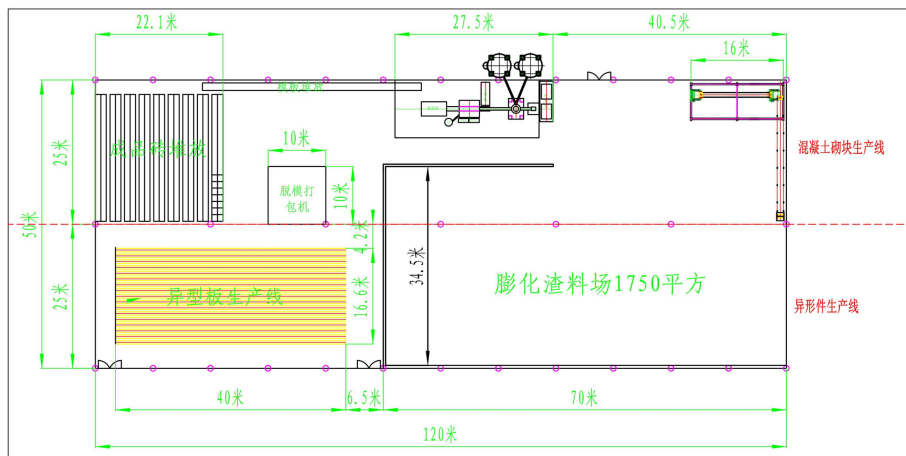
环评阶段新建厂房（异形件和混凝土砌块生产线）总平面布置示意图
